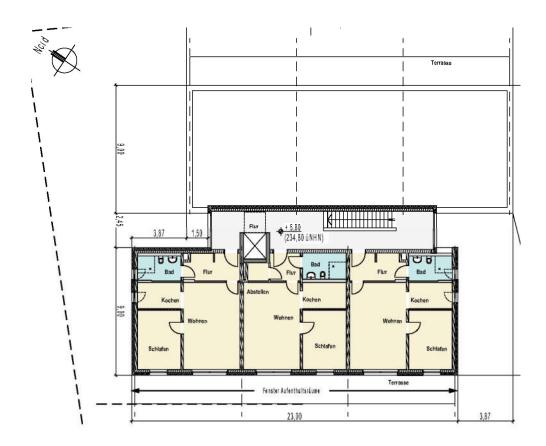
Grundriss 2. Obergeschoss / Betreutes Wohnen
